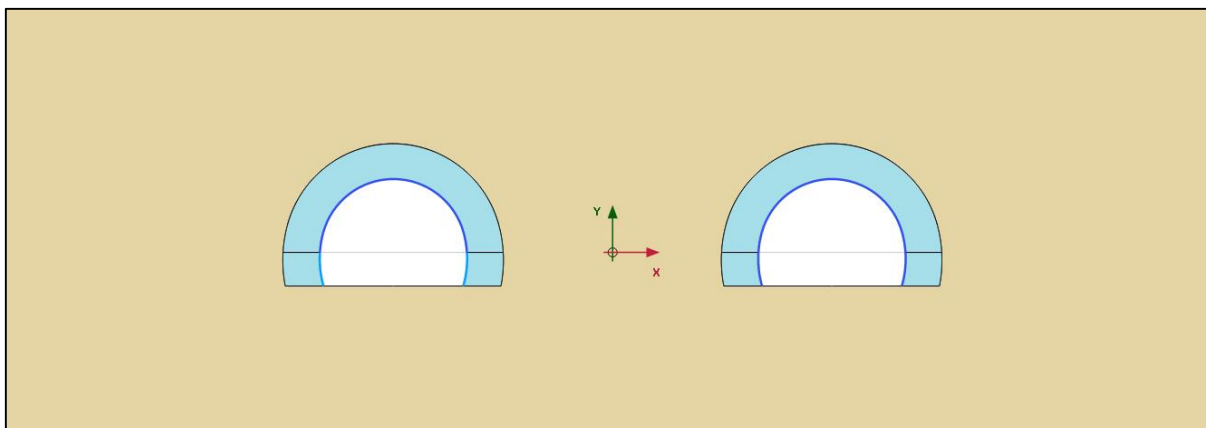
Zatěžovací stav 5 (výrub opěří JTT, dozrání stříkaného betonu v kalotě STT)
